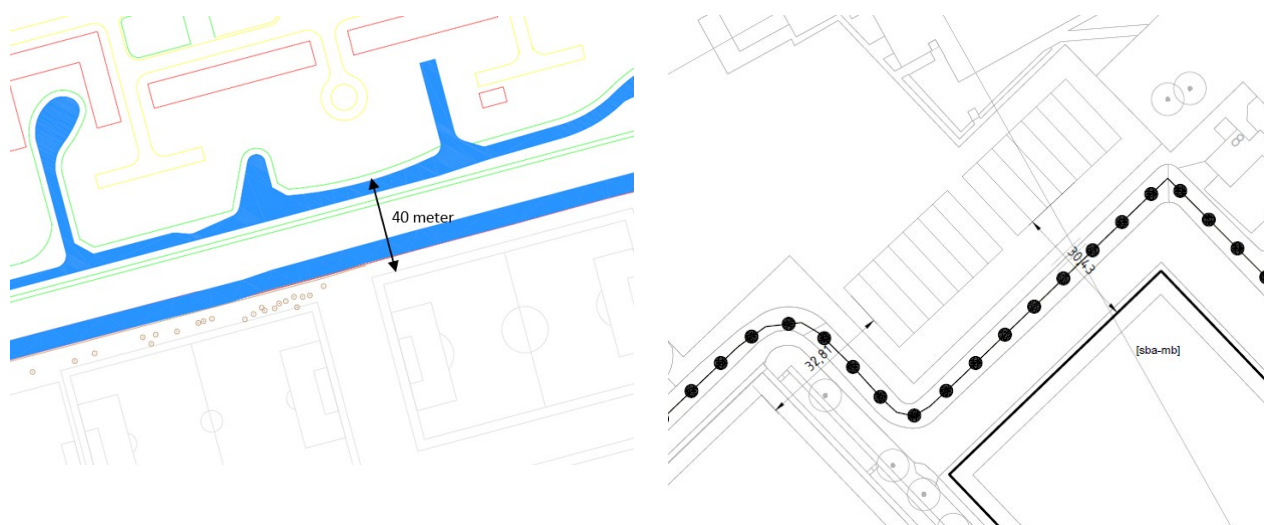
Uitsnede bestemmingsplan met de afstand tussen de woning en het bouwvlak van gebouw 'Sport en Opleiding' en het grasteam.
